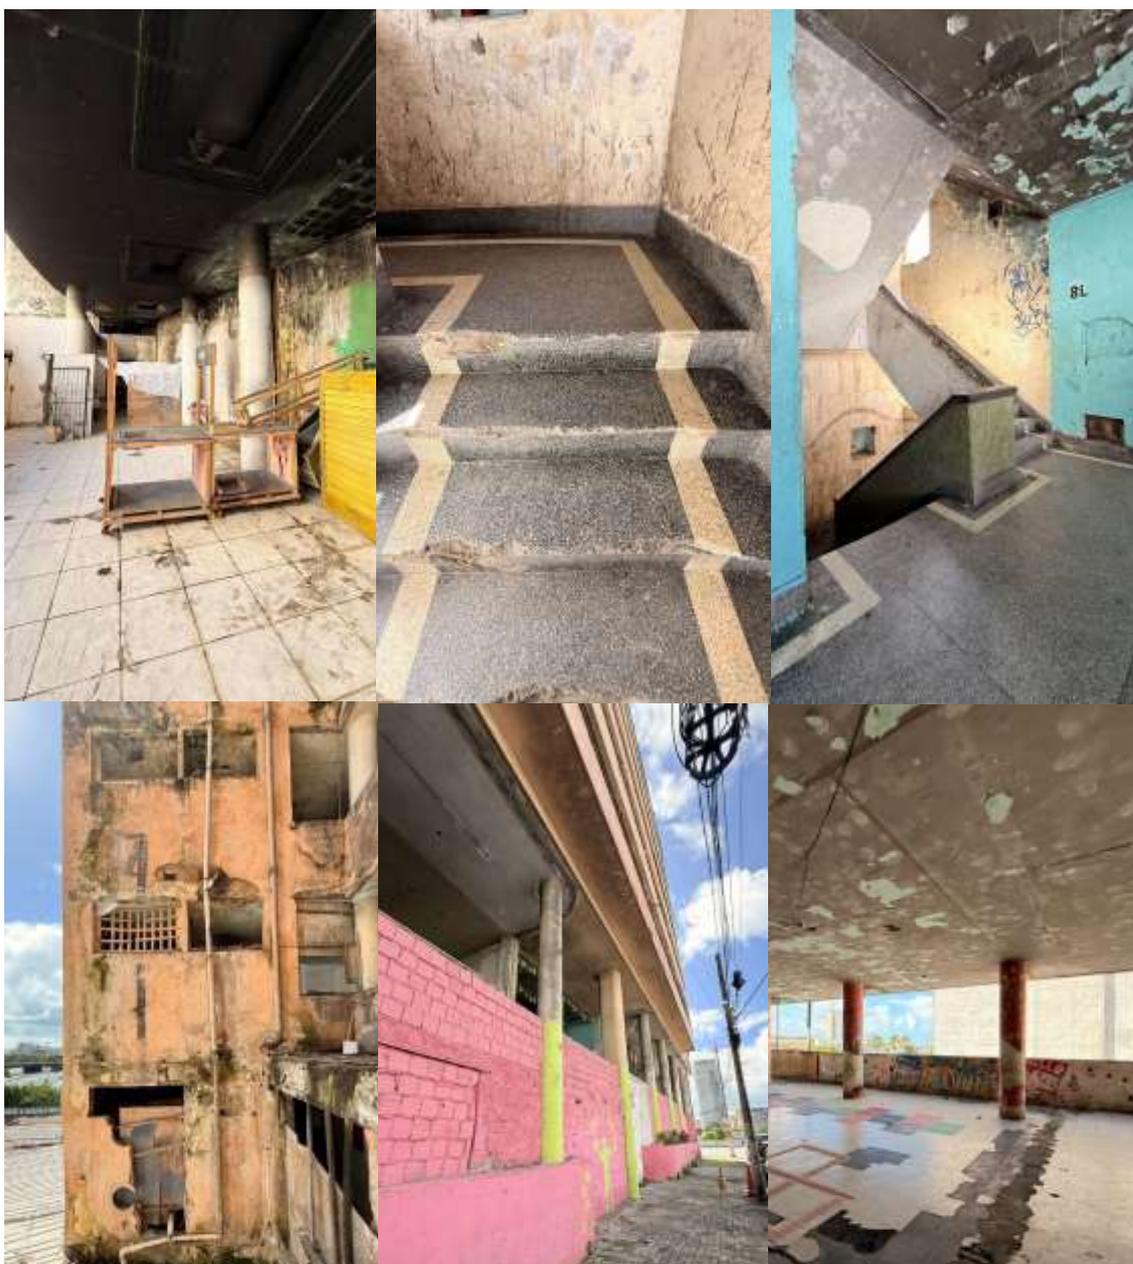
Fotomontagem do Edifício Segadas Viana. Da esquerda para direita, Acima: Vista do térreo, detalhe do estado atual da escada, hall do mezanino. Abaixo: Fachada posterior (poço de ventilação), fachada principal e mezanino. Fonte: Autora, 2025
